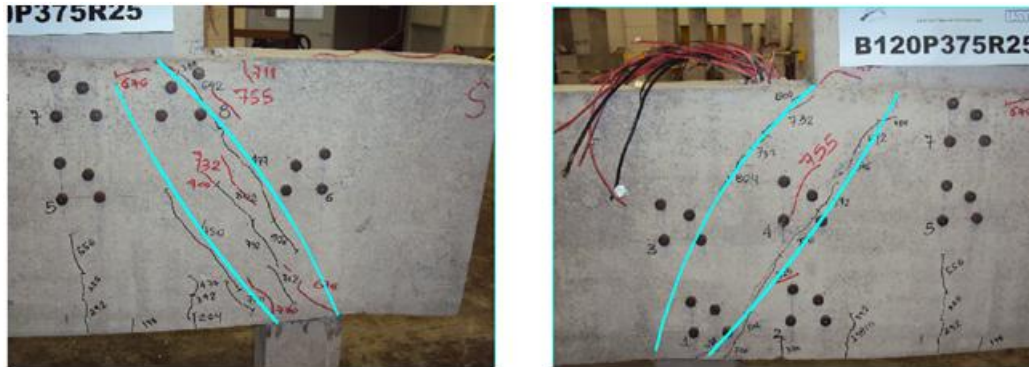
Inclinação das fissuras face sul - B120P375R25
